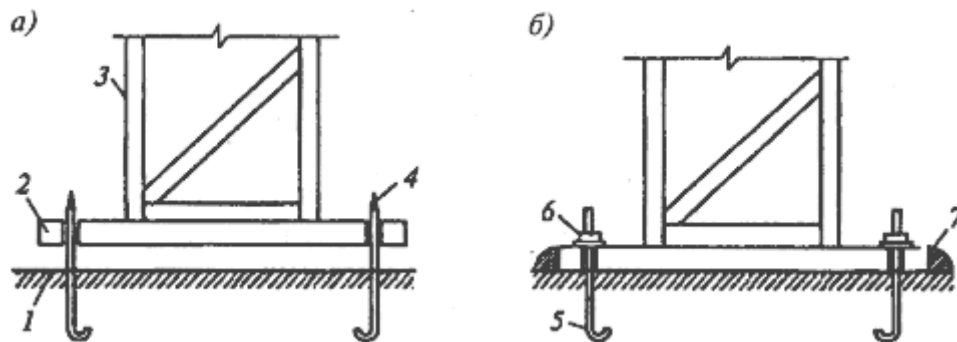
Схема установки (а) и постоянного закрепления (б) металлической колонны на опоре
